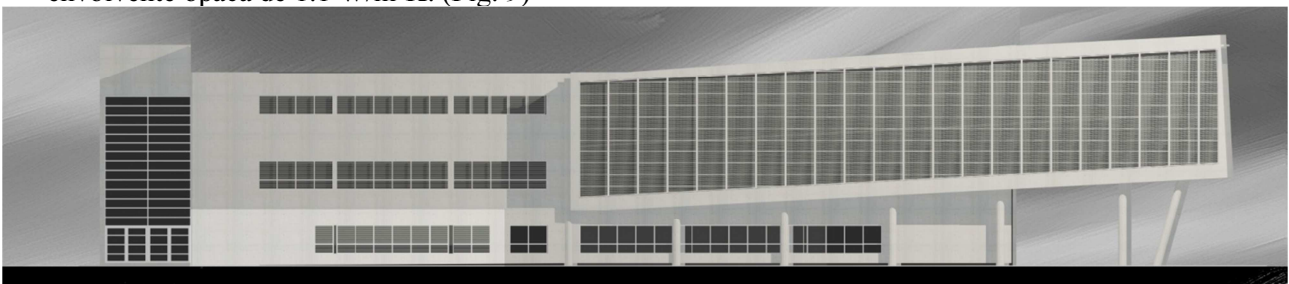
Fachada Norte propuesta. Parasoles de lamas horizontales
